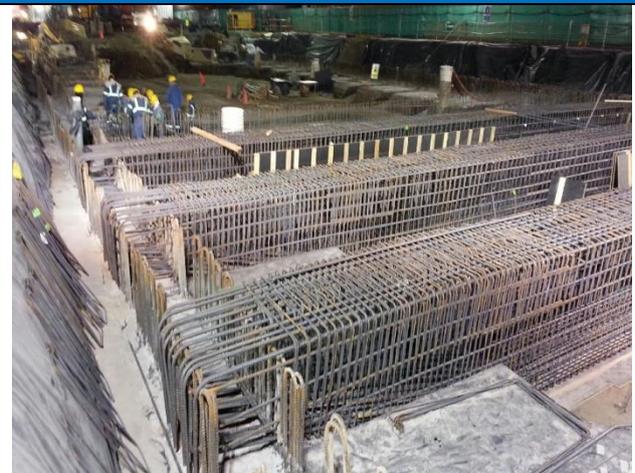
Armado de acero de refuerzo de vigas o nervios
